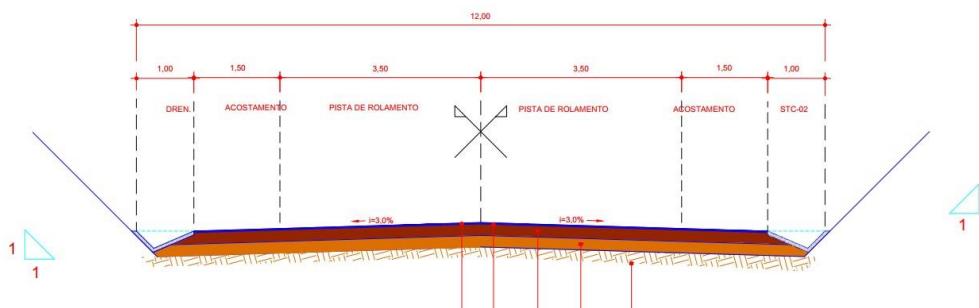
Seção-tipo de Pavimentação em Corte.
